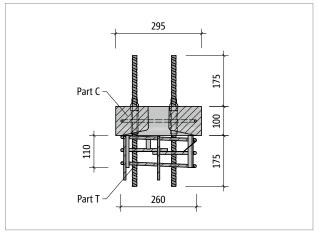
Schöck Sconnex® type P-B300 : coupe du produit Part C et Part T
